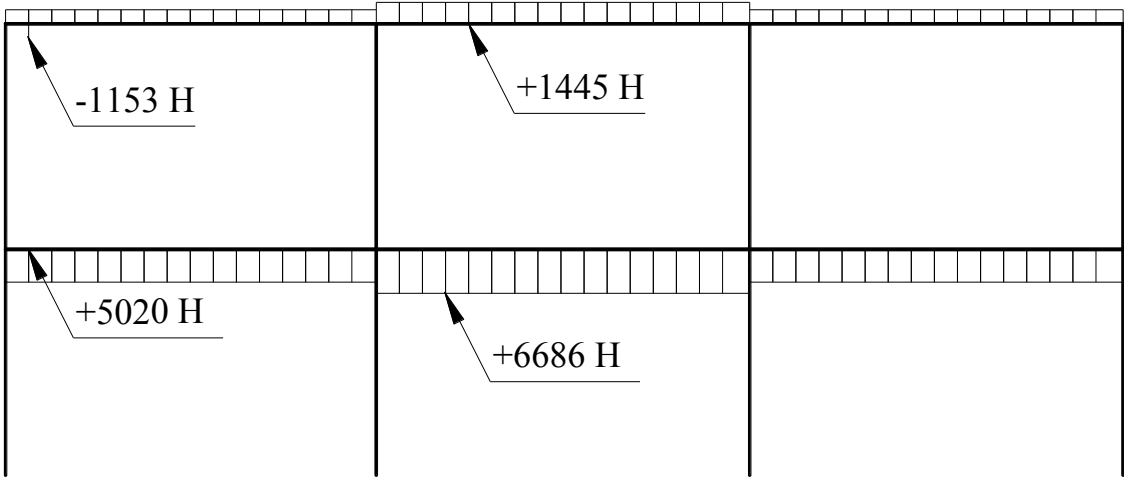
Эпюра продольных сил для 2 Варианта тепловой нагрузки
